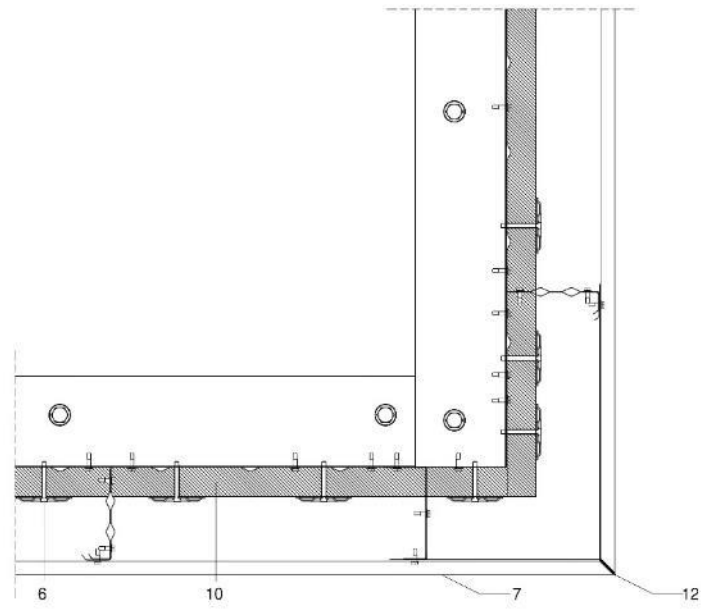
d: Detalle de esquina saliente con aislamiento térmico.
